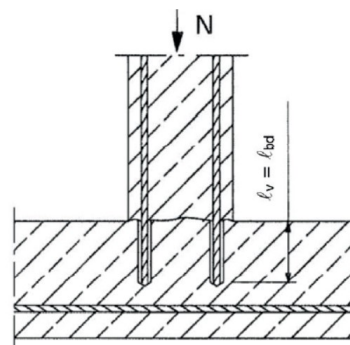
Junta superpuesta en los cimientos de un muro o columna donde las barras de refuerzo están sometidas a tensión.
